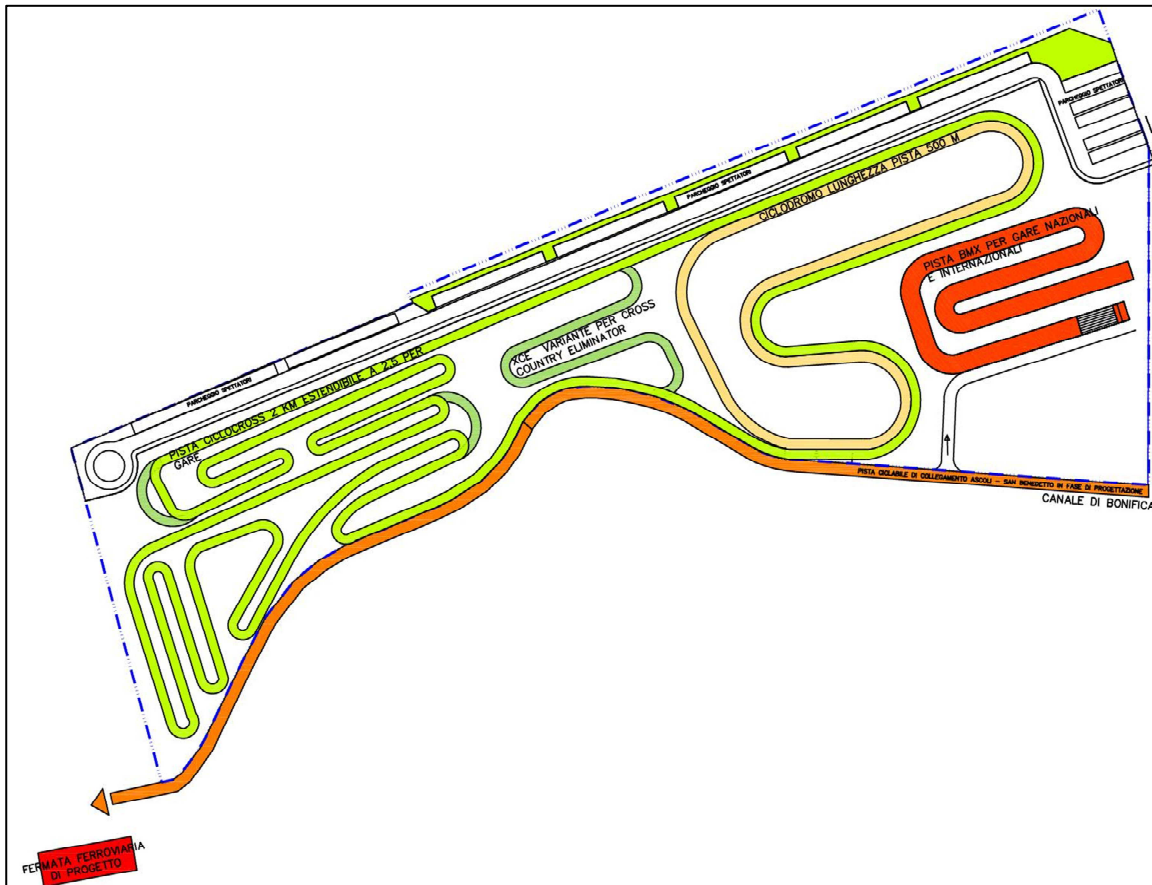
STRALCIO PLANIMETRICO BIKE PARK
